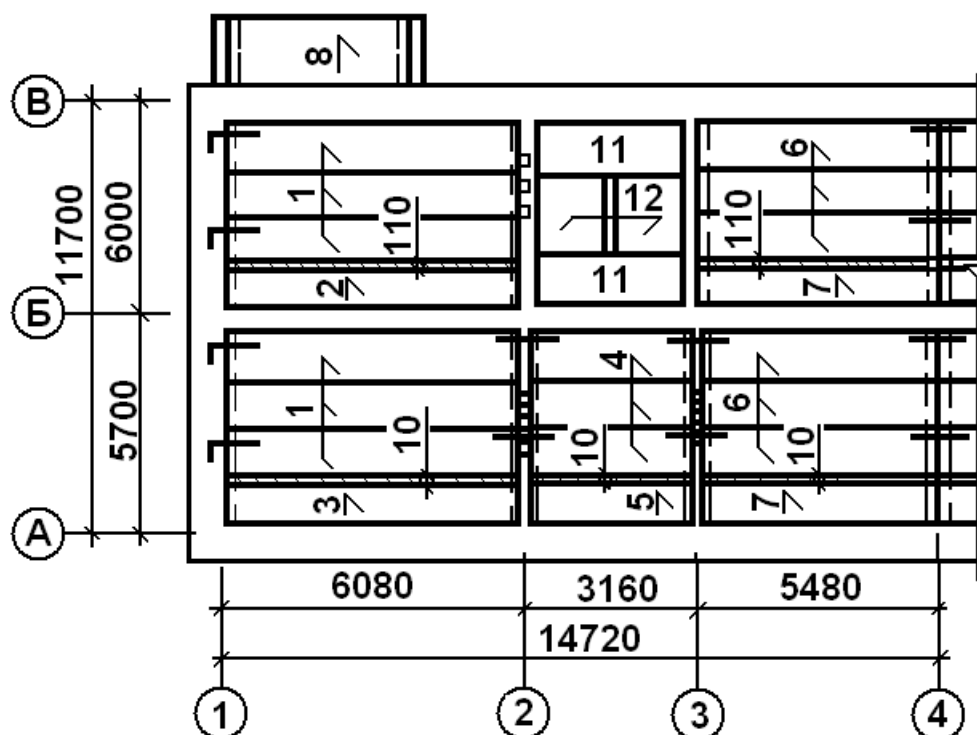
Пример плана перекрытия для здания с поперечными несущими стенами
